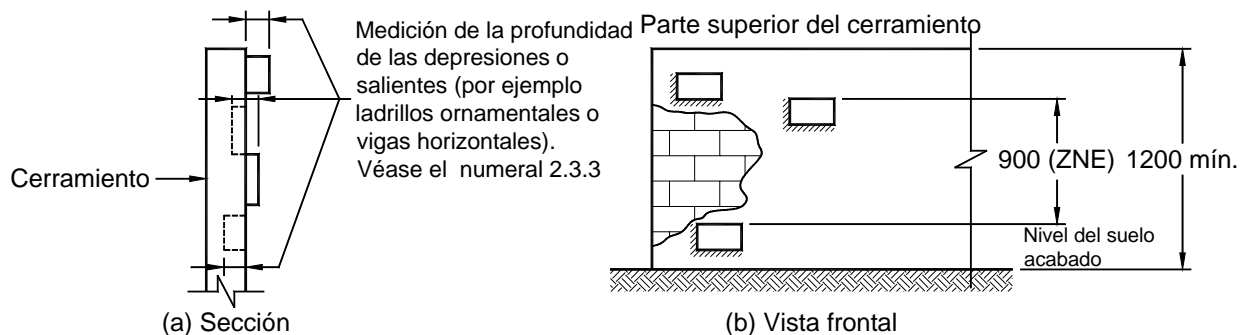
(Final) Dimensiones perpendiculares del cerramiento
